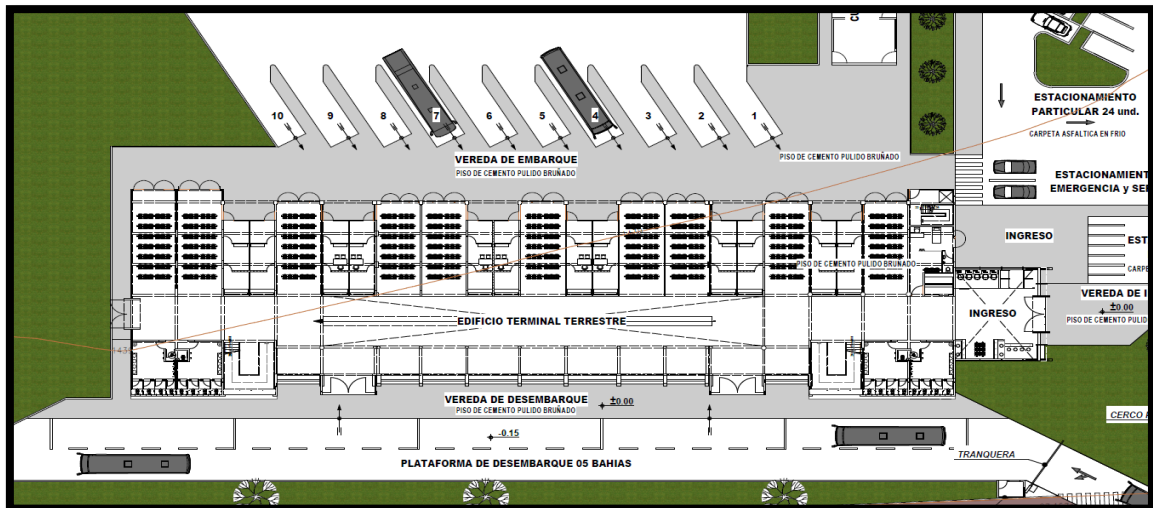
Planimetría del primer nivel (fuente expediente técnico)
